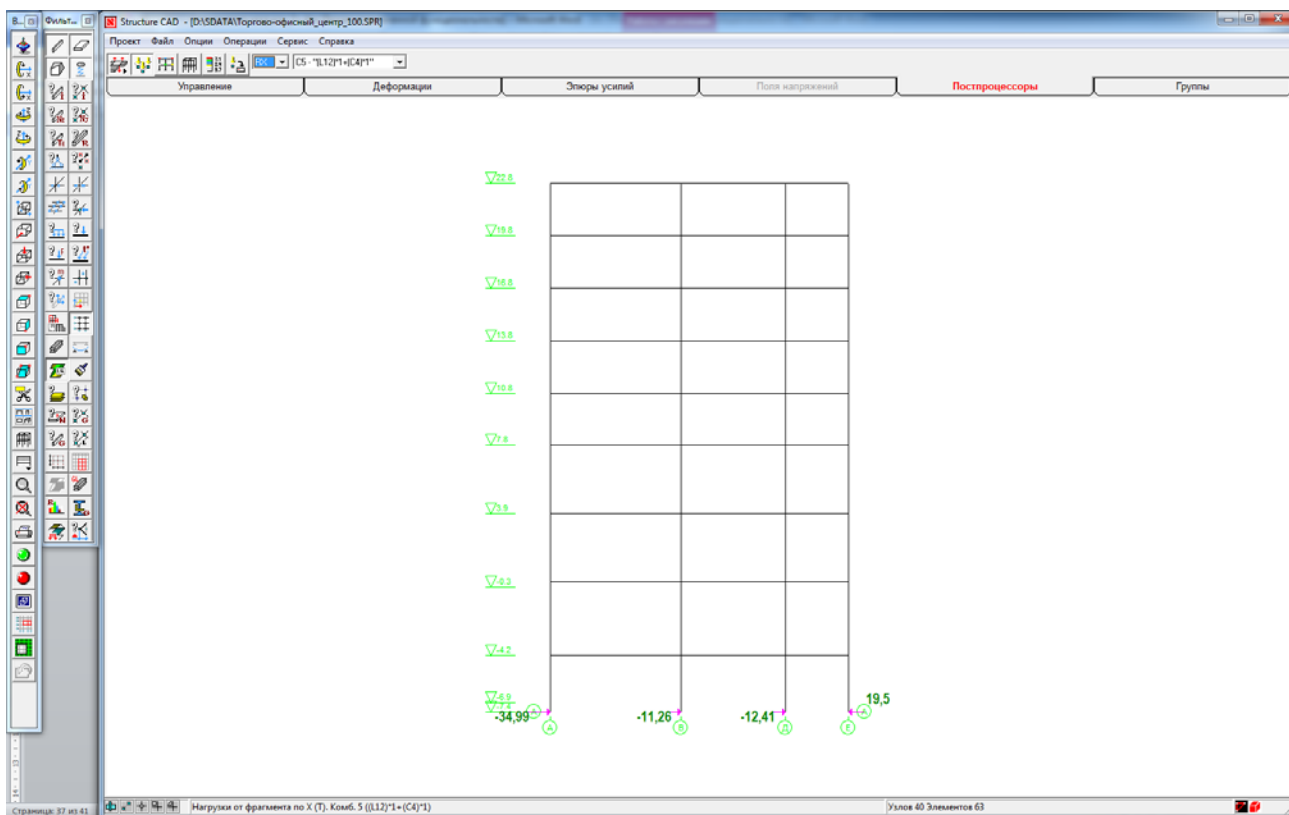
Горизонтальные нагрузки на фундаменты колонн от четвертой комбинации нагрузок (все вертикальные нагрузки).
